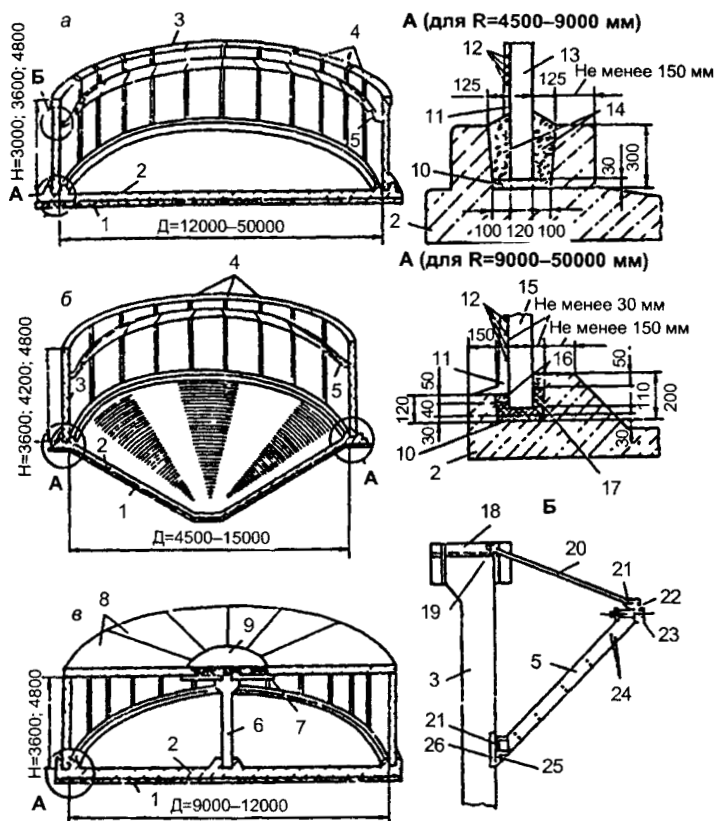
Конструктивно-монтажные схемы цилиндрических емкостных сооружений из типовых унифицированных сборных элементов и деталей:
